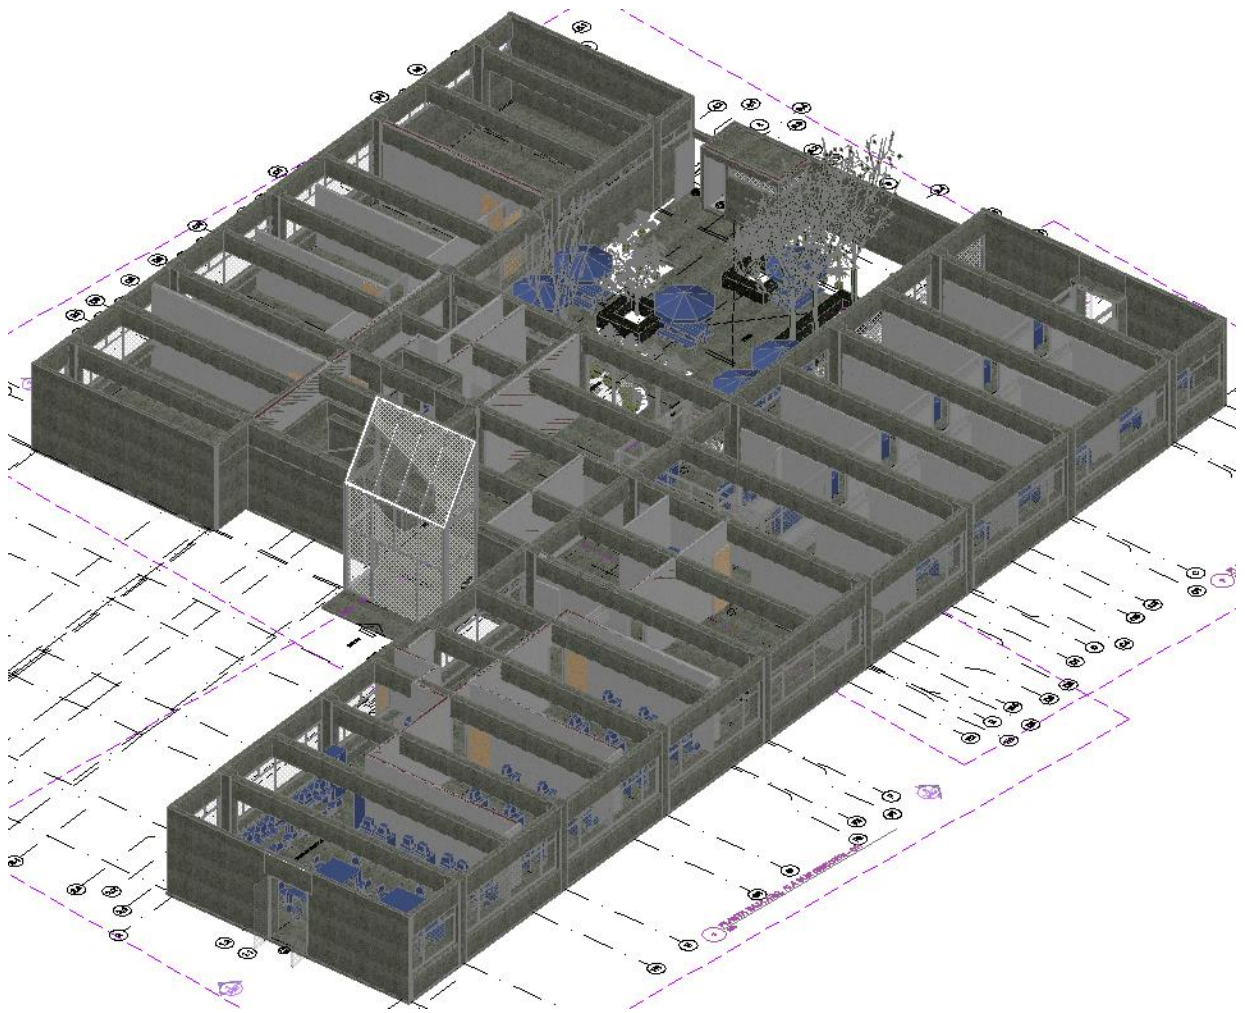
Modelo arquitectónico localizando las secciones de la Vista de la Planta Baja ya remodelada.
